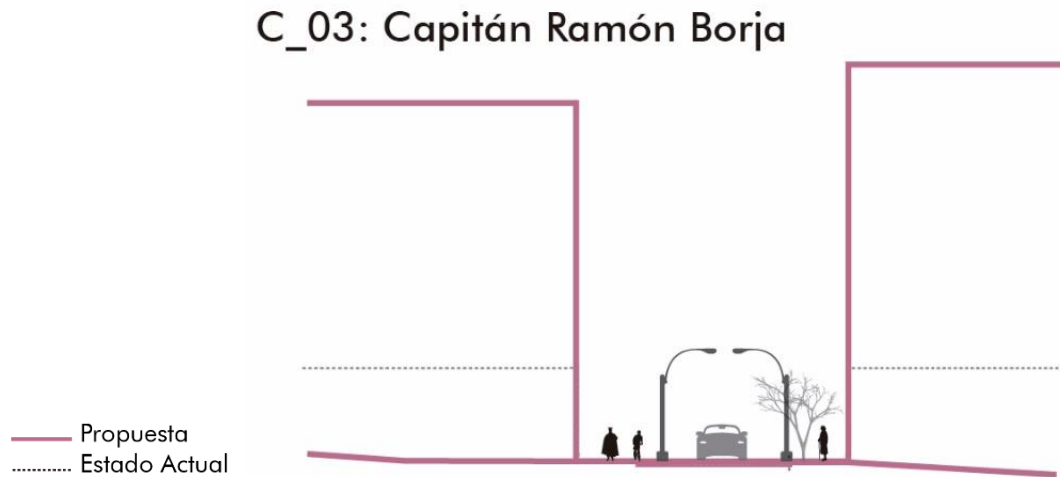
Corte transversal en la calle Capitán Ramón Borja, situación actual y proyectada. (Elaborado por: Jaire Cagigal)
